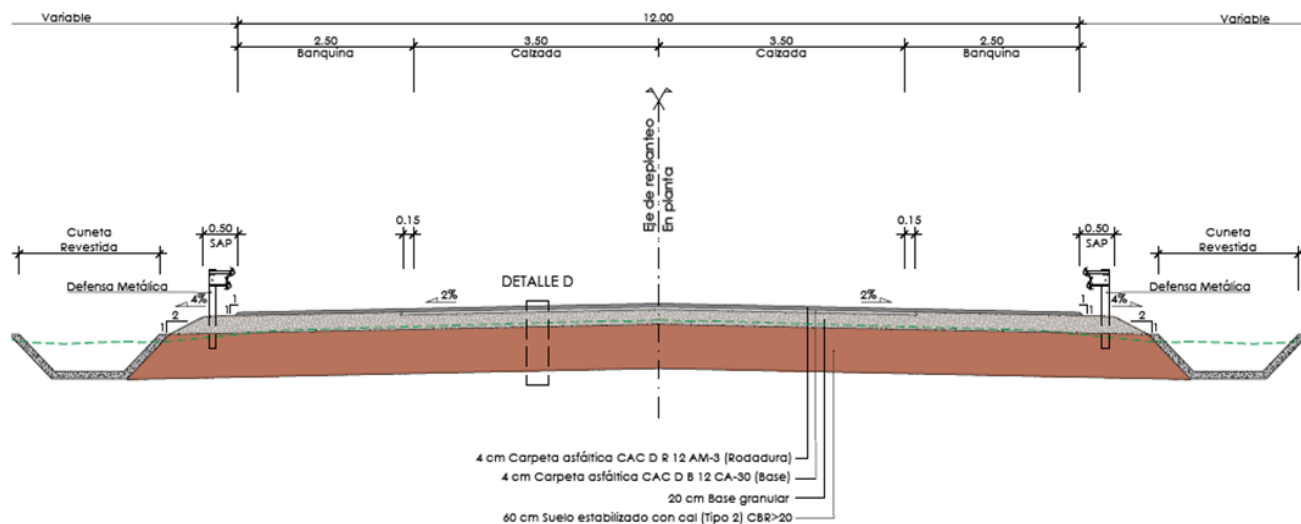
Sección tipo de obra básica y estructura de pavimento, Gral. Bruguez
